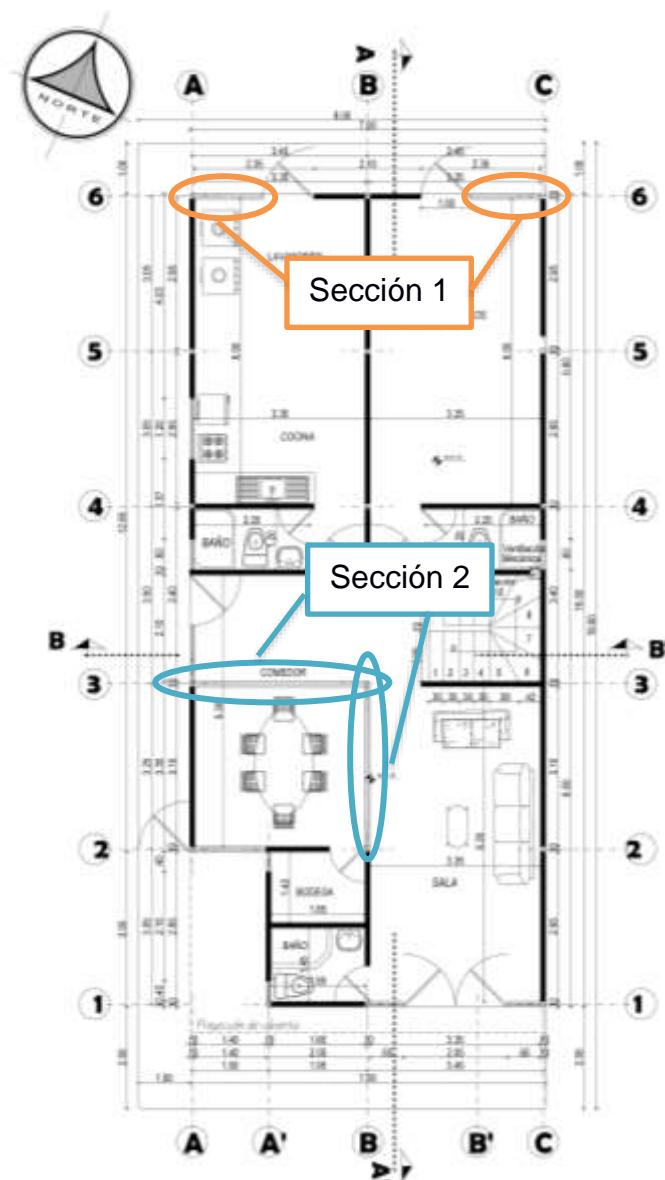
Vista en Planta – Secciones de Muros [Martínez & Villamar, 2023]
